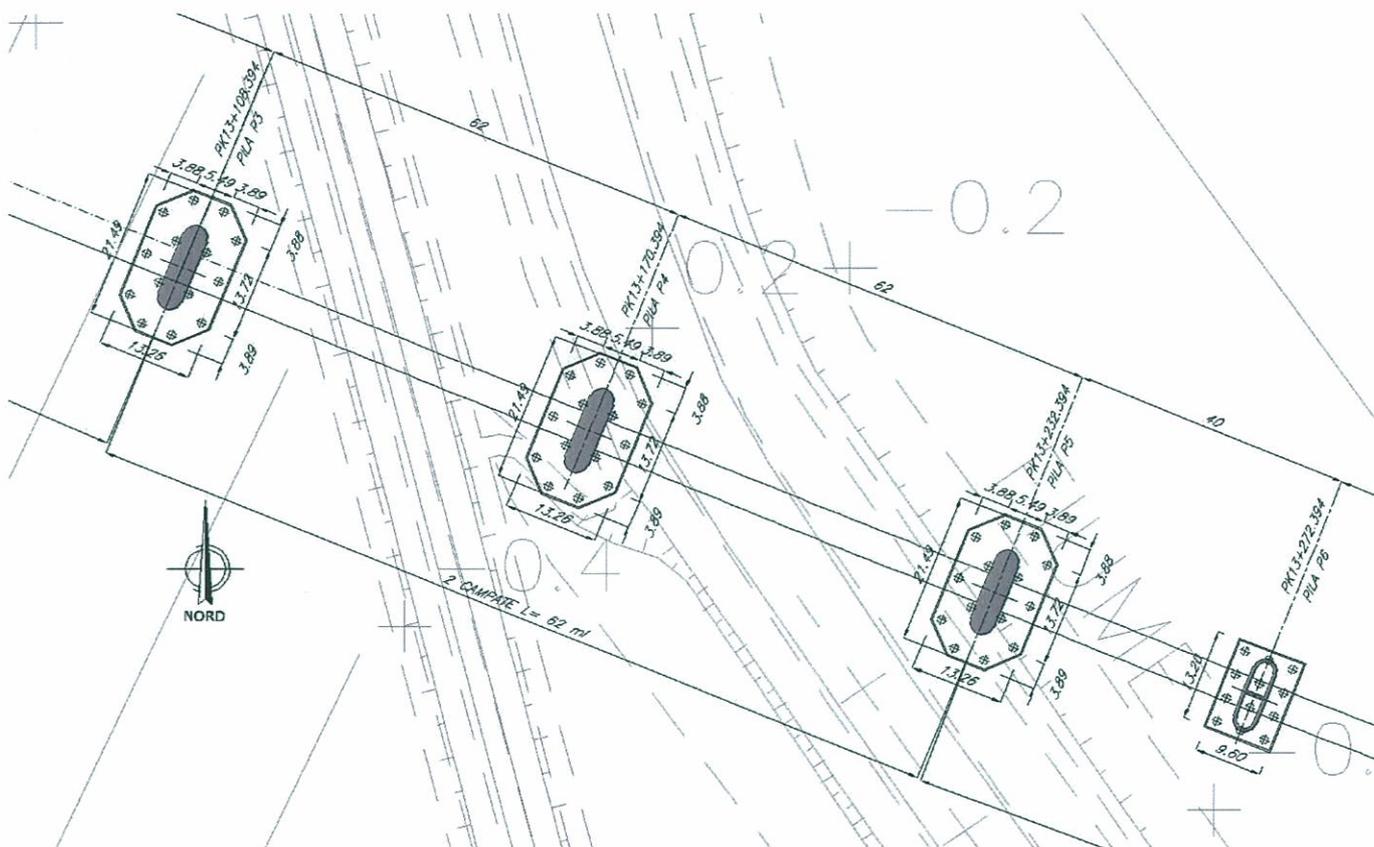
Pianta dell'attraversamento del Canale Piovega e del Fiume Vallo.
